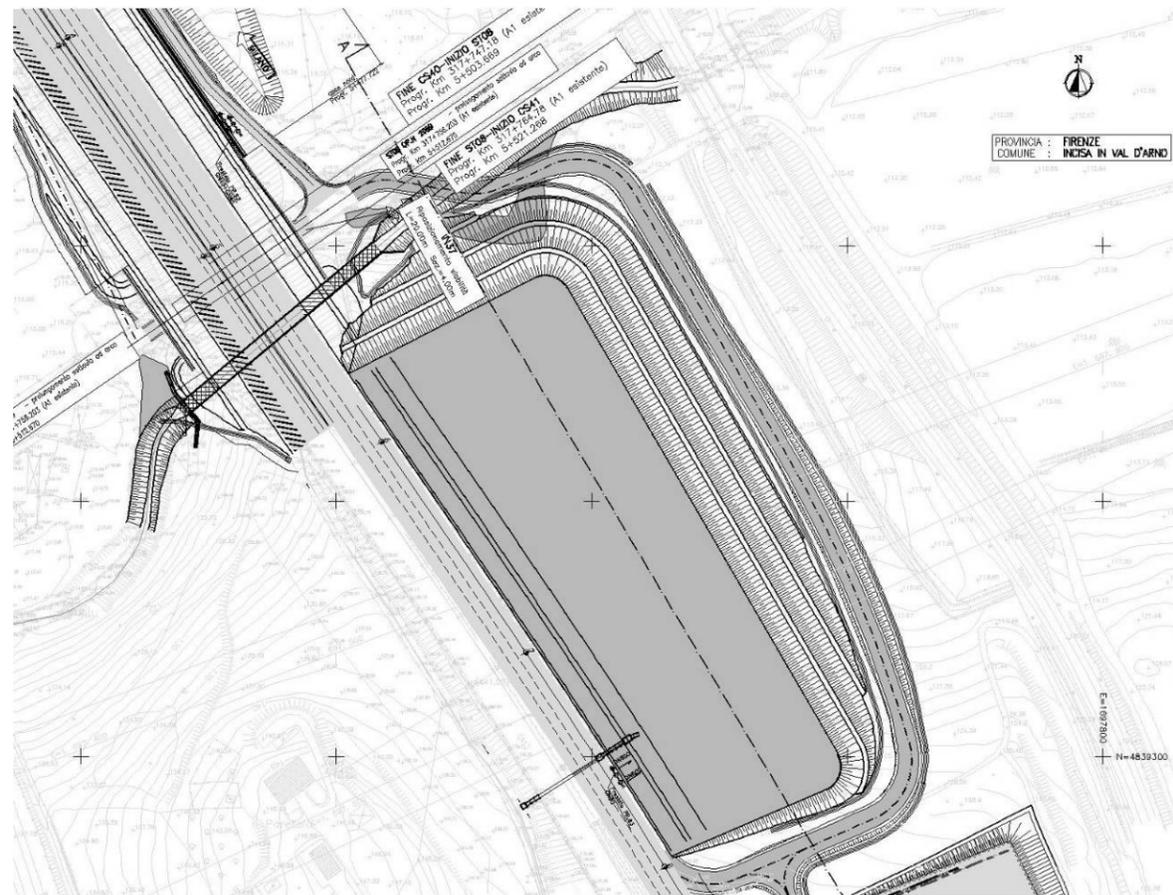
Zona Burchio: rimodellamento del progetto approvato dalla Cds
